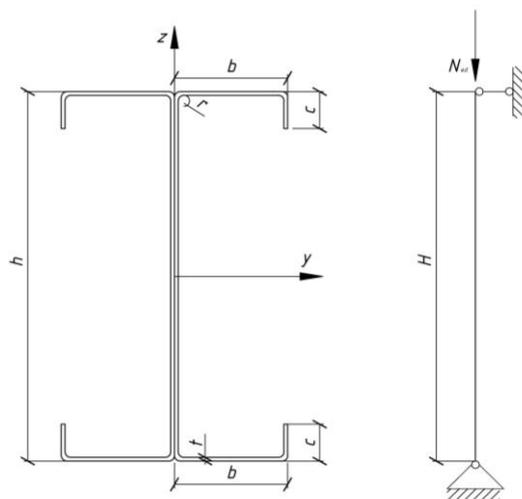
Расчетная схема и схема поперечного сечения стойки
